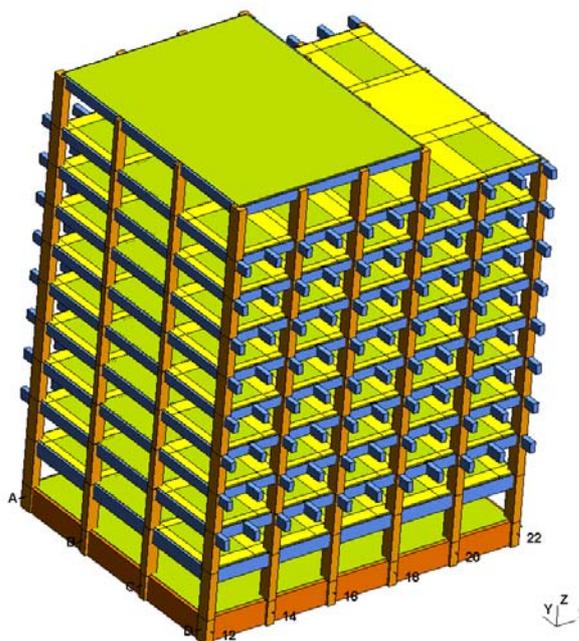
Vue 3D des planchers, poutres et poteaux
